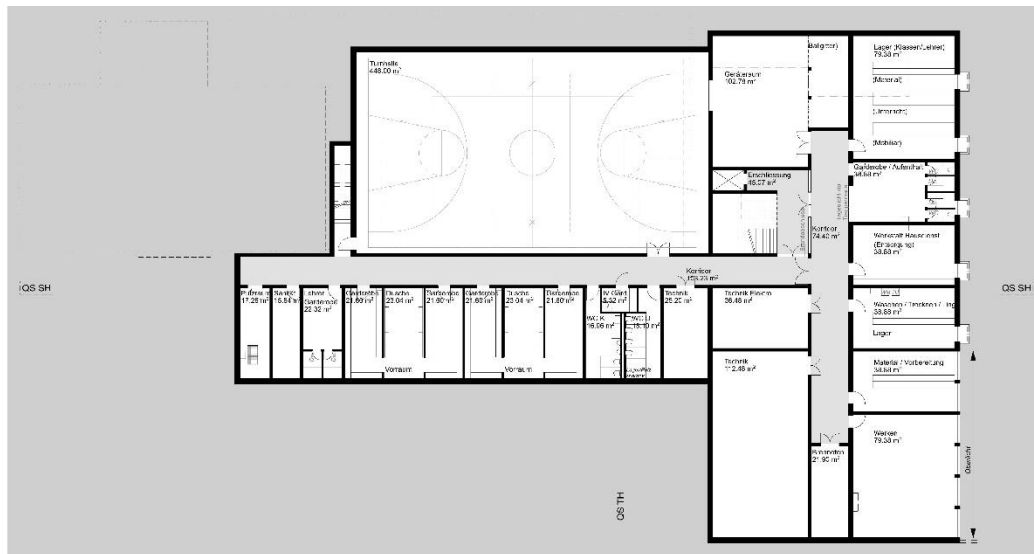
Grundriss Untergeschoss Vorprojekt
